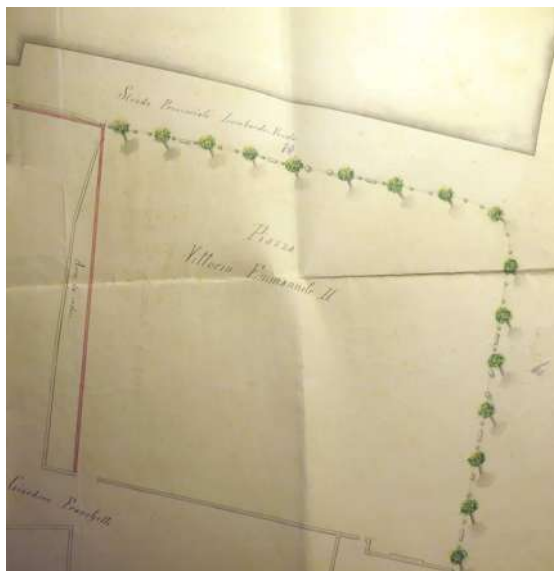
Progetto Balossi di rettifica muro divisorio Franchetti e cessione di area pubblica
